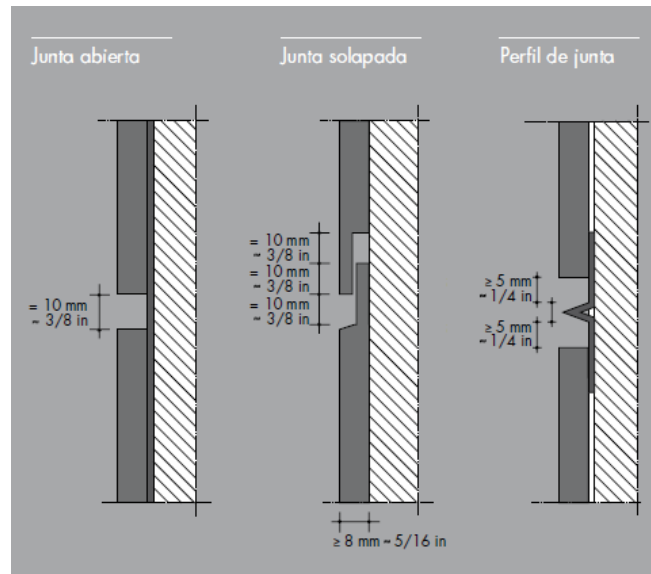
Juntas horizontais (neste caso sem caixa-de-ar) (www.trespa.com)
